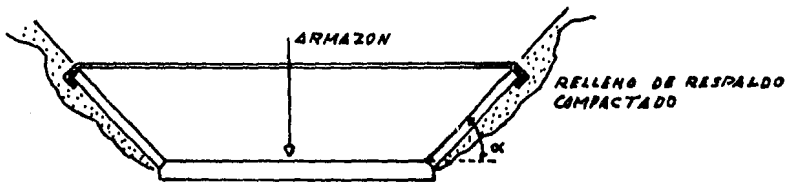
Ubicación de las losas precoladas en canales pequeños.
